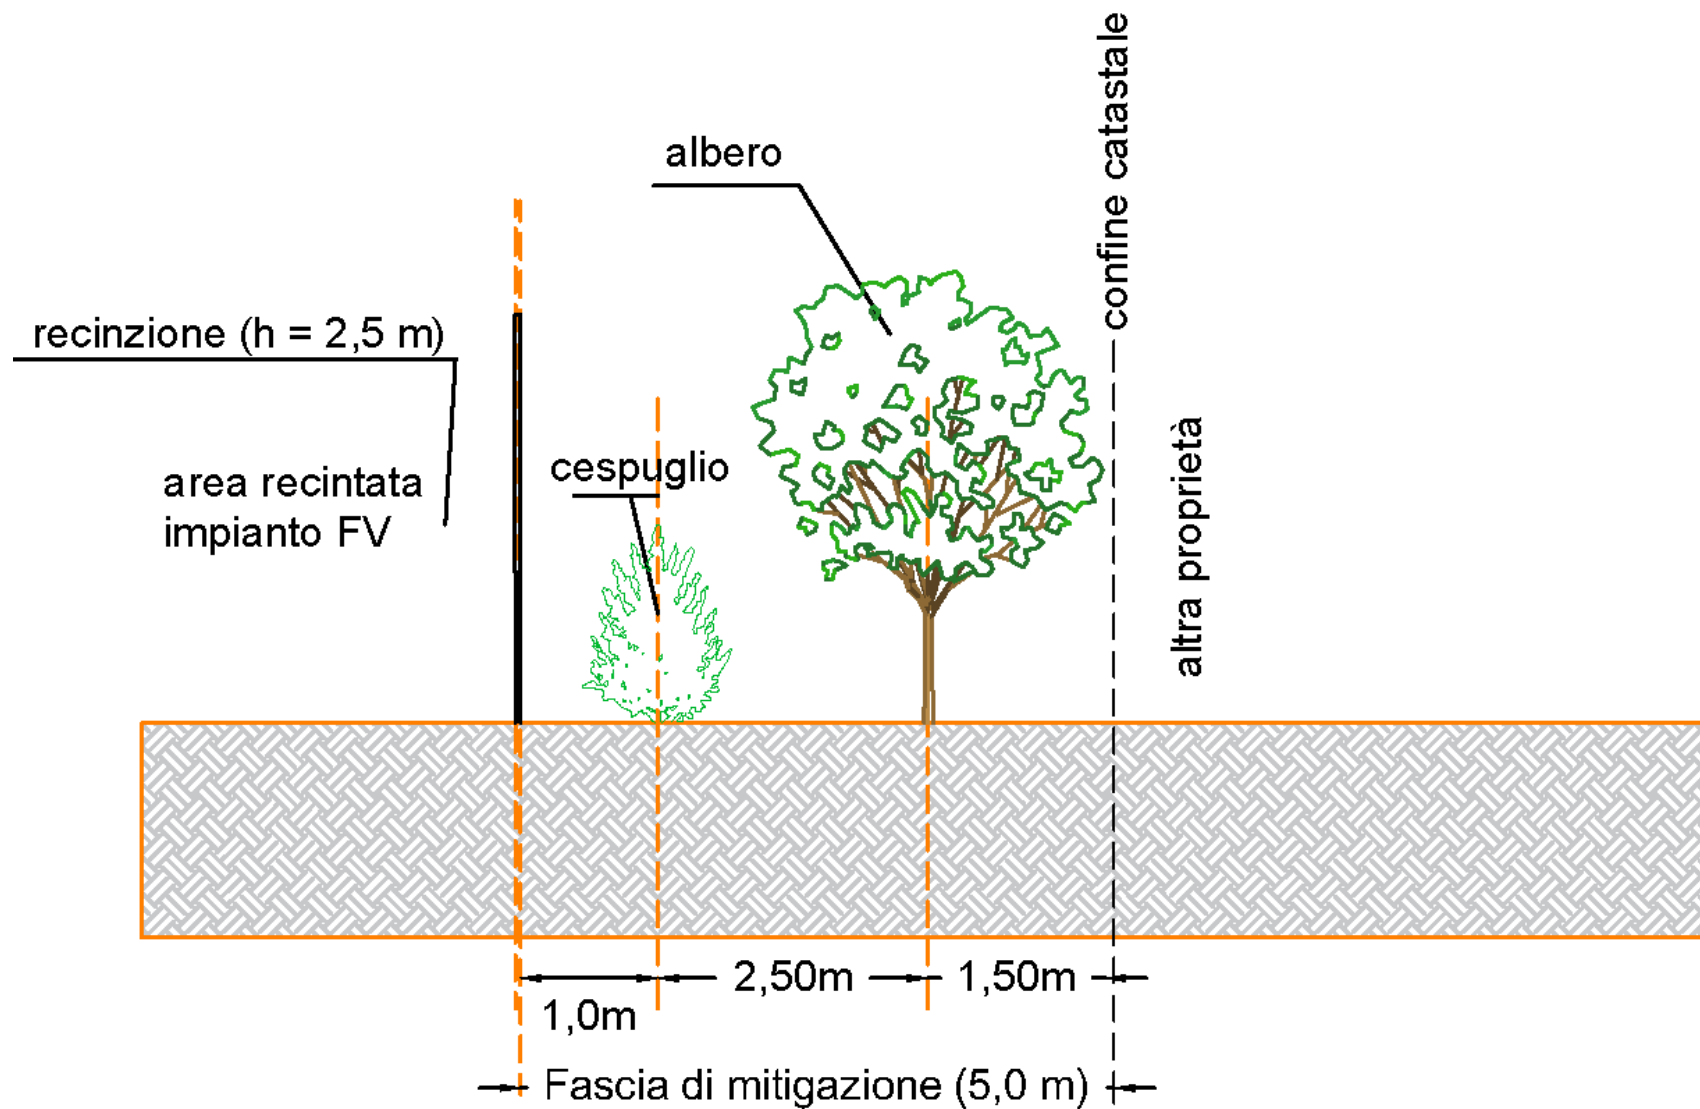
Stralcio di sezione dell'area perimetrale dell'impianto.
